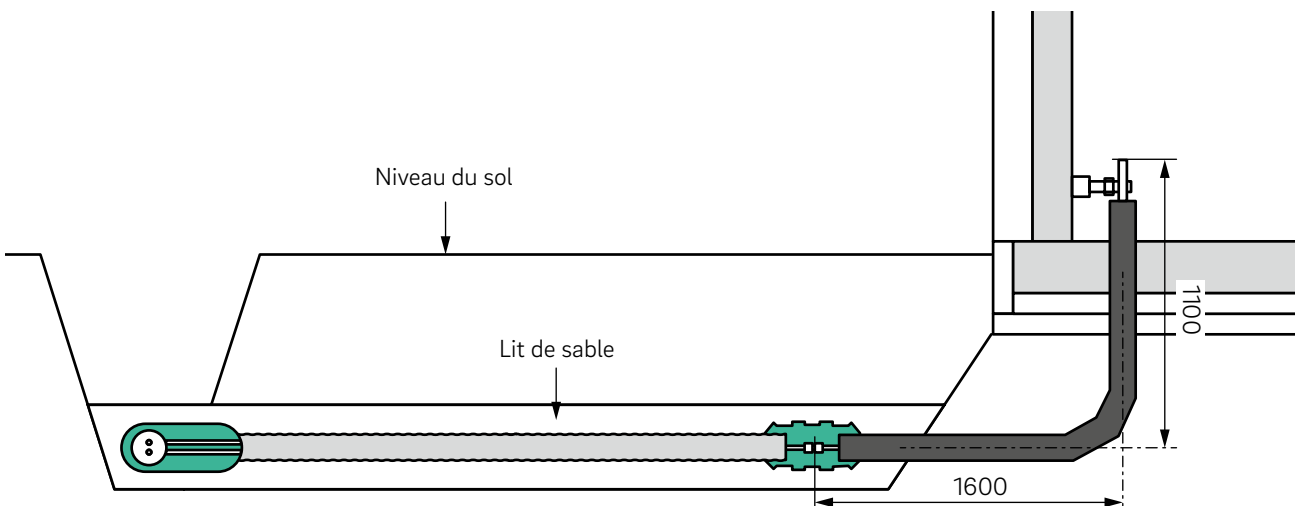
Dimensions du coude d'amenée (fixe)
